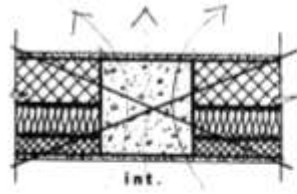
A-1: Pilastro di facciata: ponte termico non corretto.
